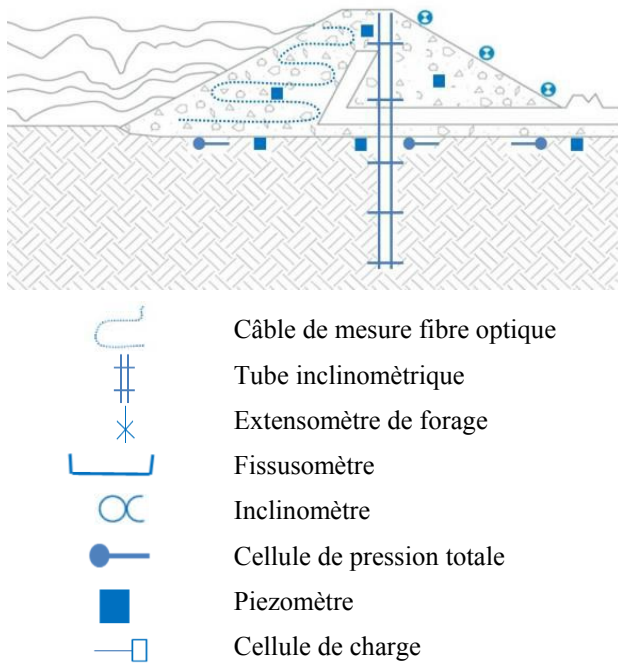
SCHEMA TYPE INSTRUMENTATION D'UN BARRAGE EN REMBLAI
